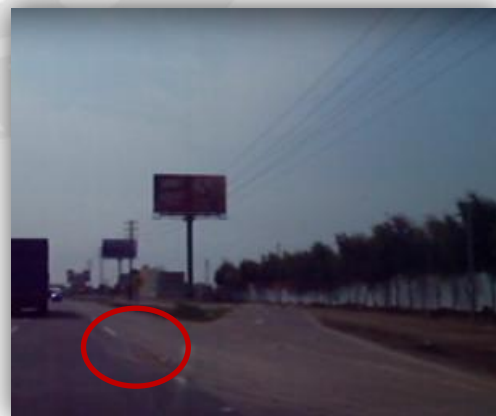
Pavimento con baches y grietas profundas.
